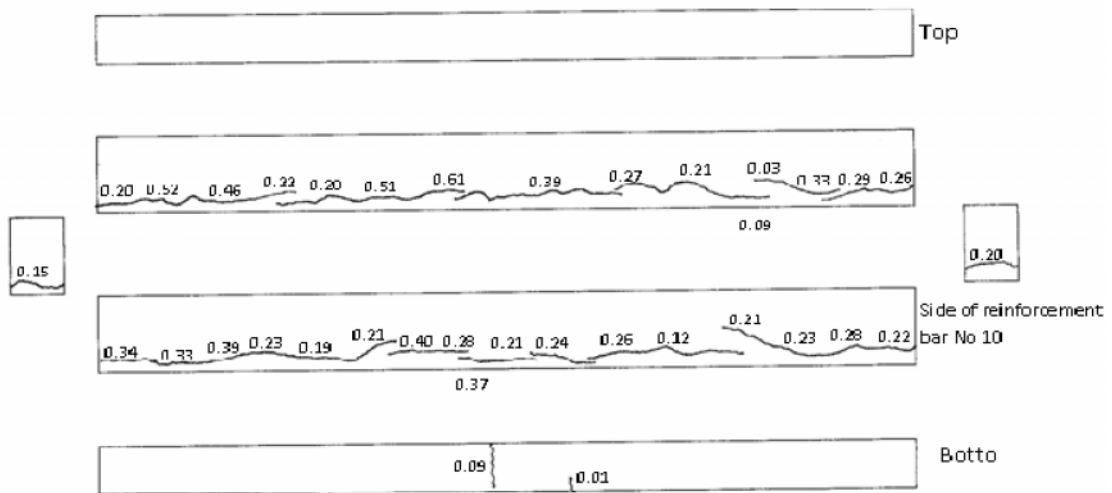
Schéma de fissuration de la poutre (2T12 20 kN) avec les ouvertures des fissures de corrosion en mm.
